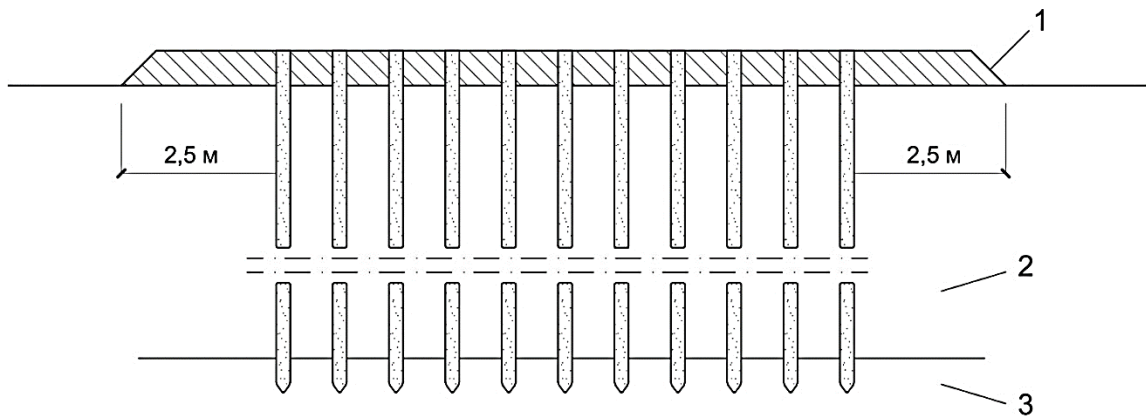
Поперечний переріз насипу з піщаними палями-дренами:
